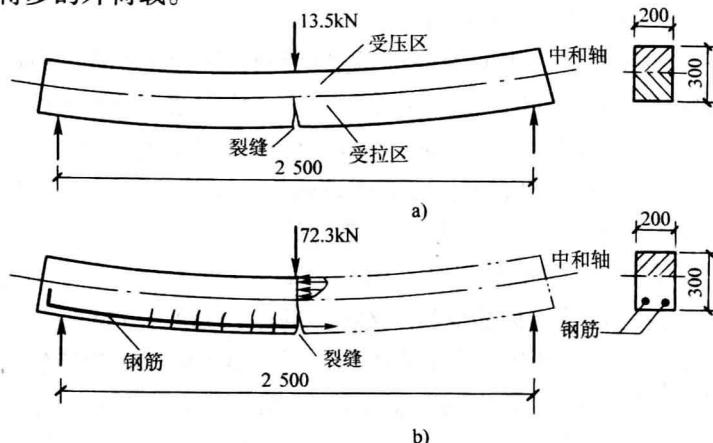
混凝土及钢筋混凝土简支梁的承载力
